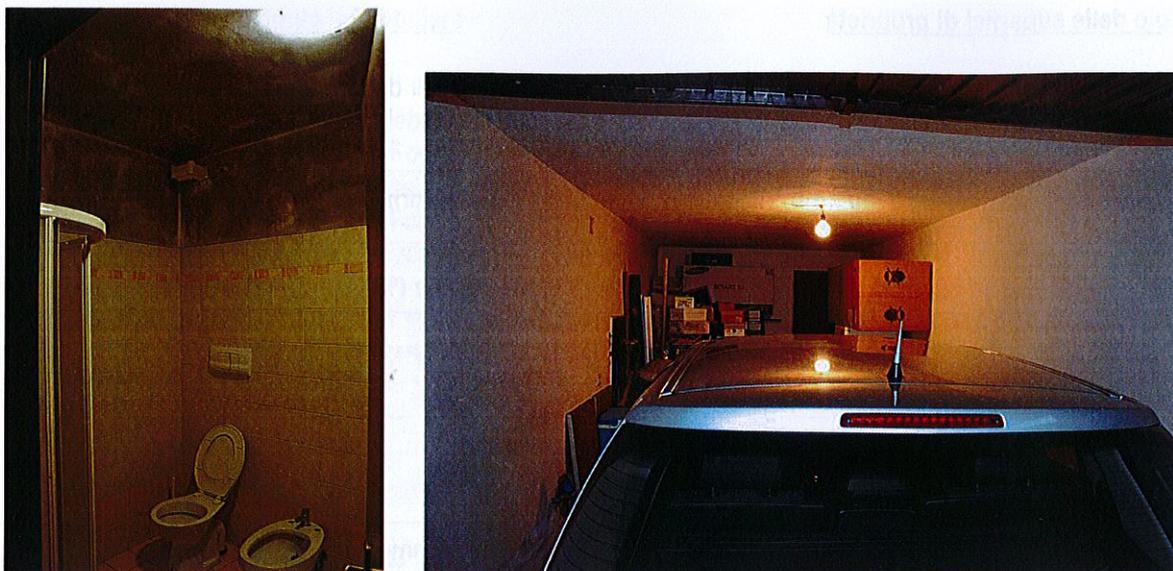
Finiture dell'appartamento e dell'autorimessa
